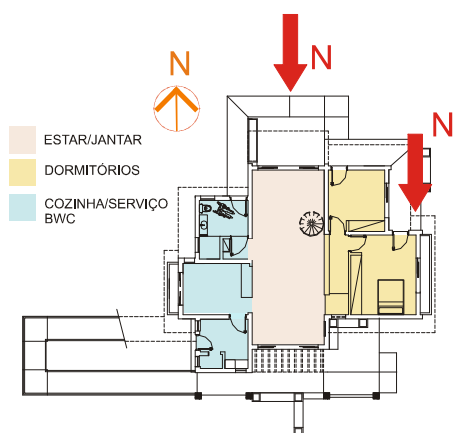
Planta baixa da edificação, indicando-se a incidência dos ventos predominantes.
